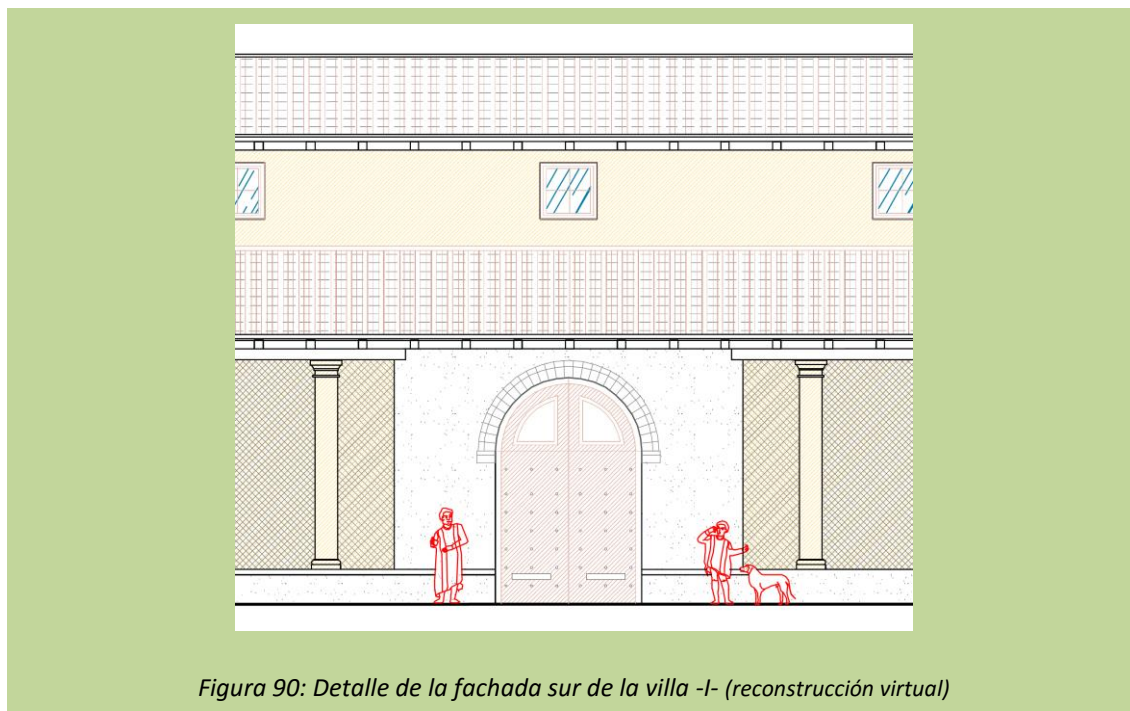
Detalle de la fachada sur de la villa -I- (reconstrucción virtual)
